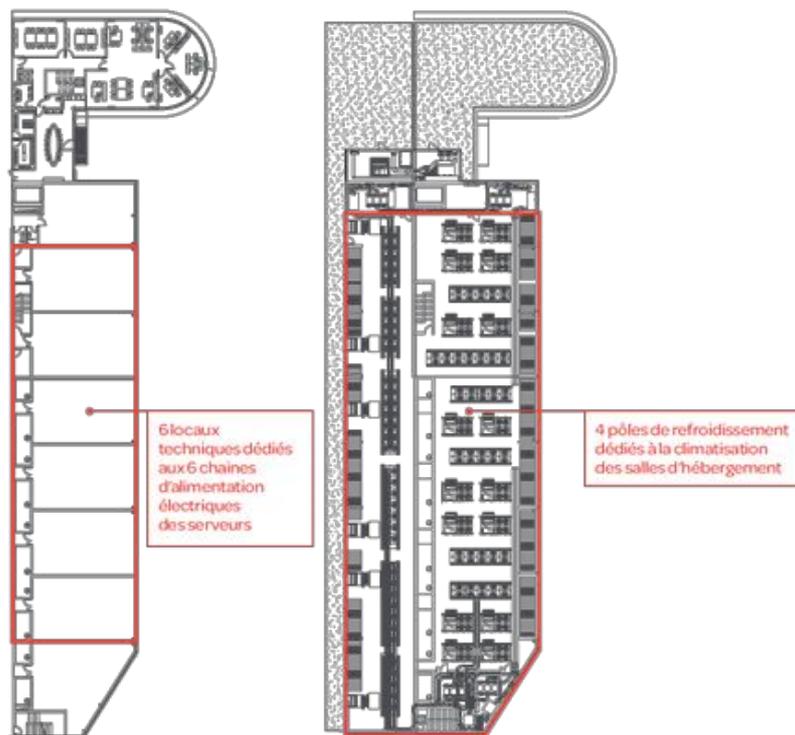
Plan de terrasse technique du carrier hotel TC3 Condorcet de TelecityGroup
